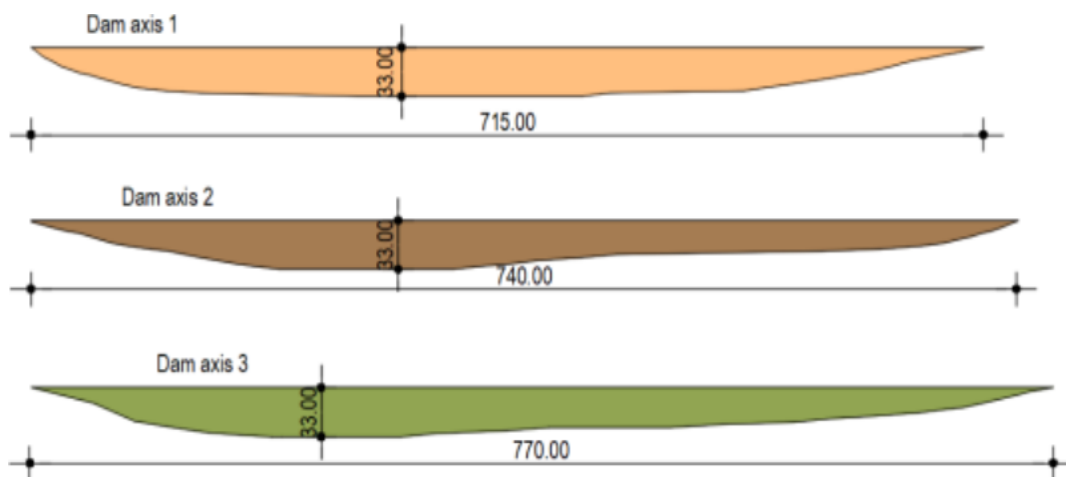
Secções longitudinais da barragem nos locais examinados
